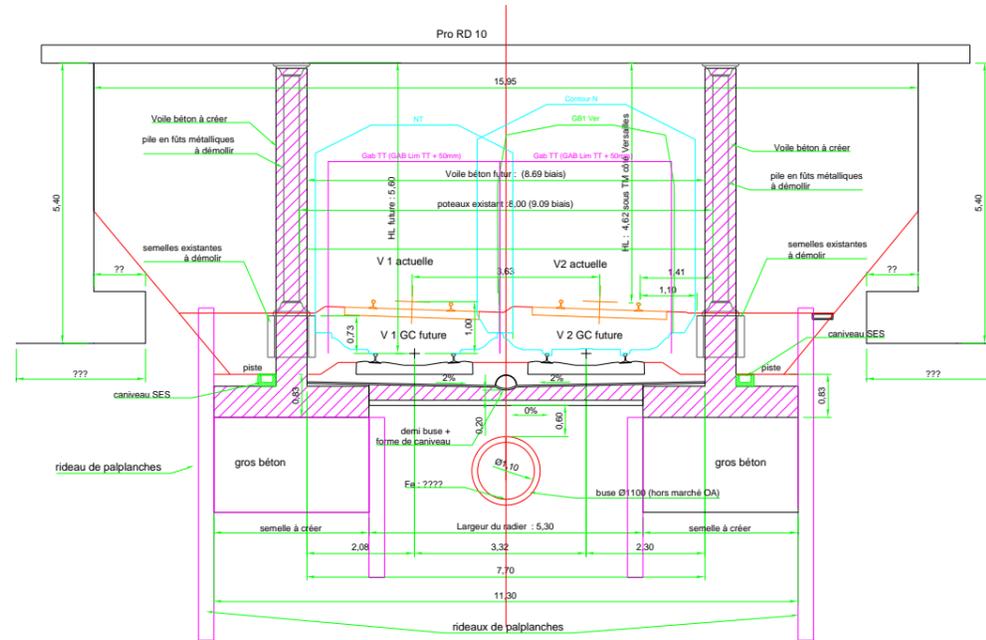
Coupe du Pont Route de la RD10 (Source : AVP- juillet 2015)
